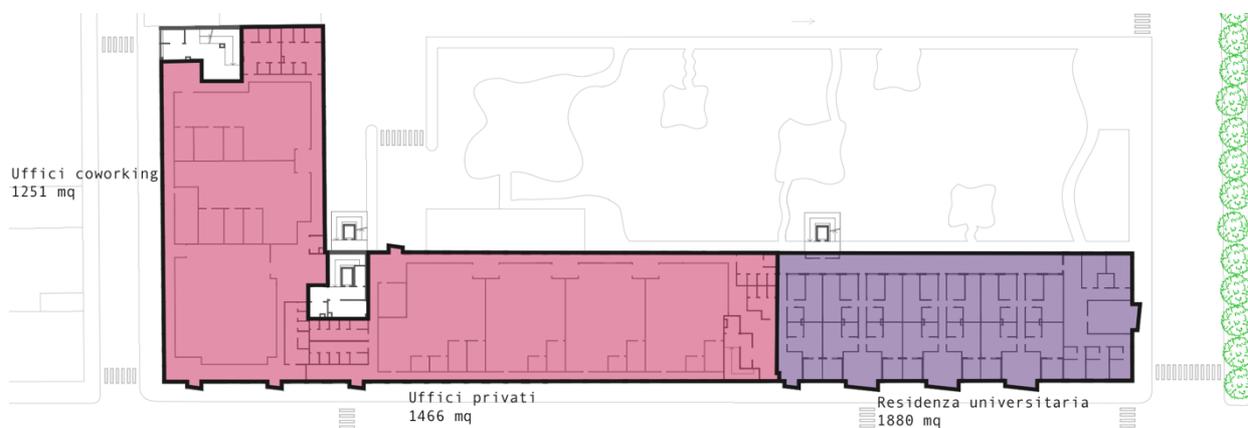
Distribuzione al primo piano. Pianta non in scala. Estratto da tavola 3.
